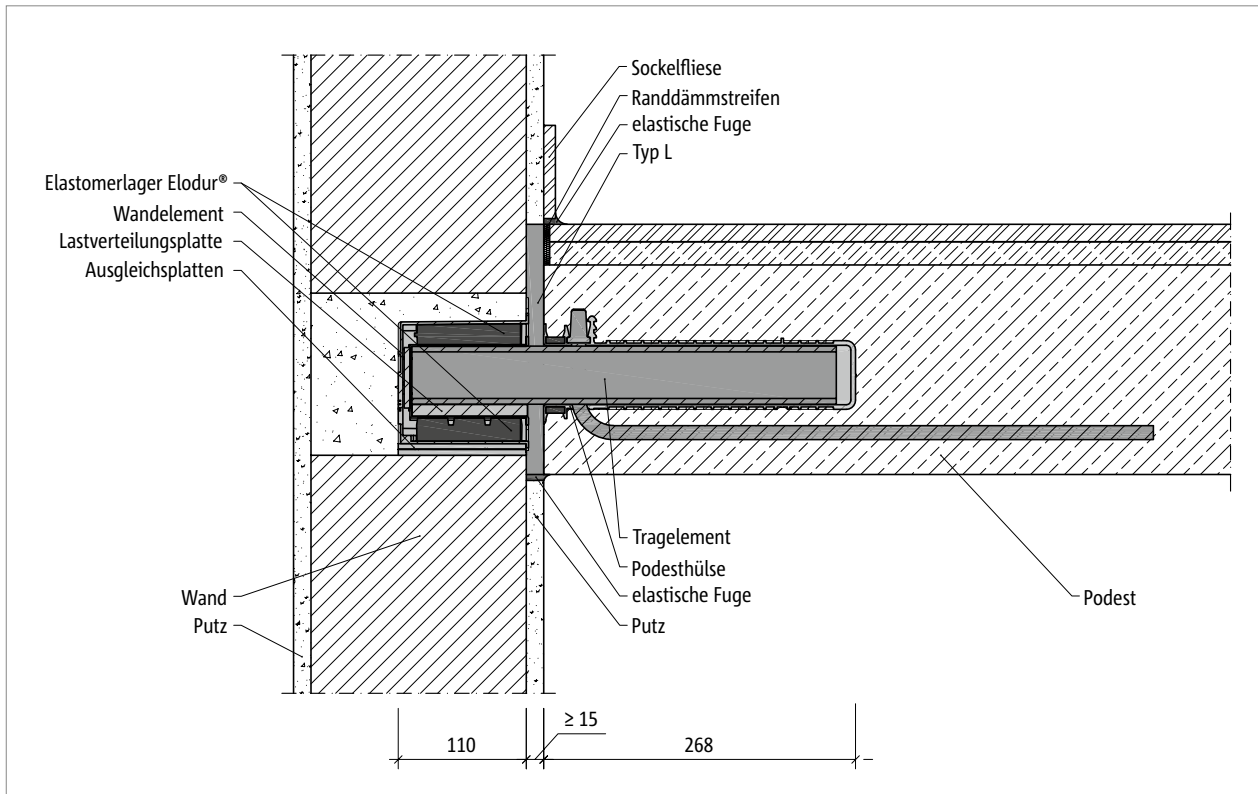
Schöck Tronsole® Typ P: mit Ortbetonpodest und Tronsole® Typ L
